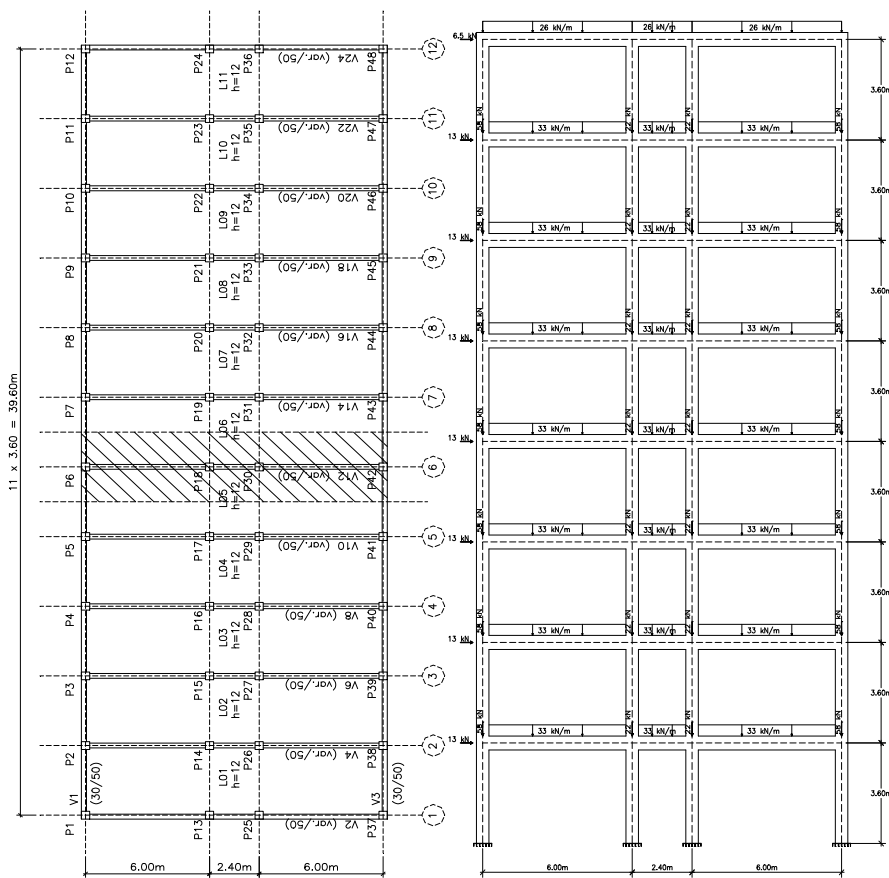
Geometria do edifício de 8 pavimentos e do pórtico analisado
